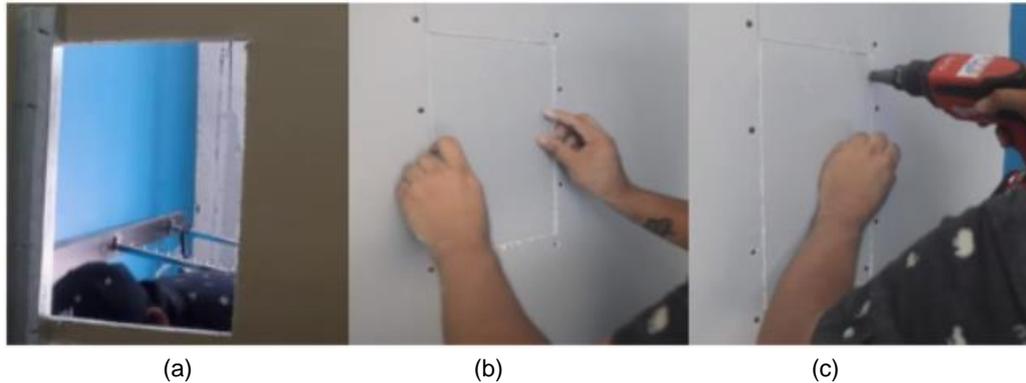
Sellado de agujero perfilado. (a): Colocado de parantes de drywall tras el agujero existente, (b): Colocado de bloque de drywall en agujero, (c): Fijación de bloque en panel a resanar mediante atornillador eléctrico.
